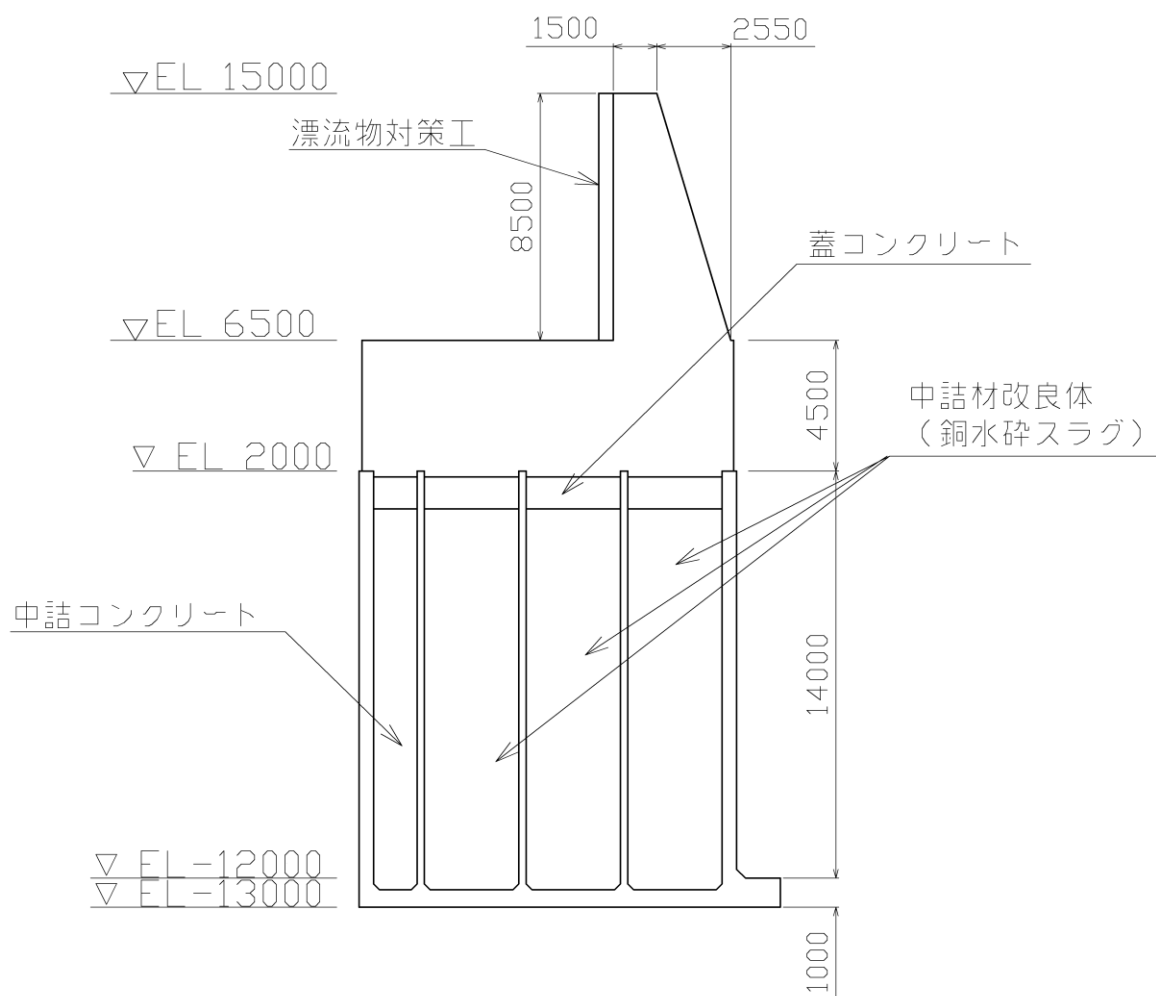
(3) 防波壁 (波返重力擁壁) の構造図 (断面図) (②-②断面)
